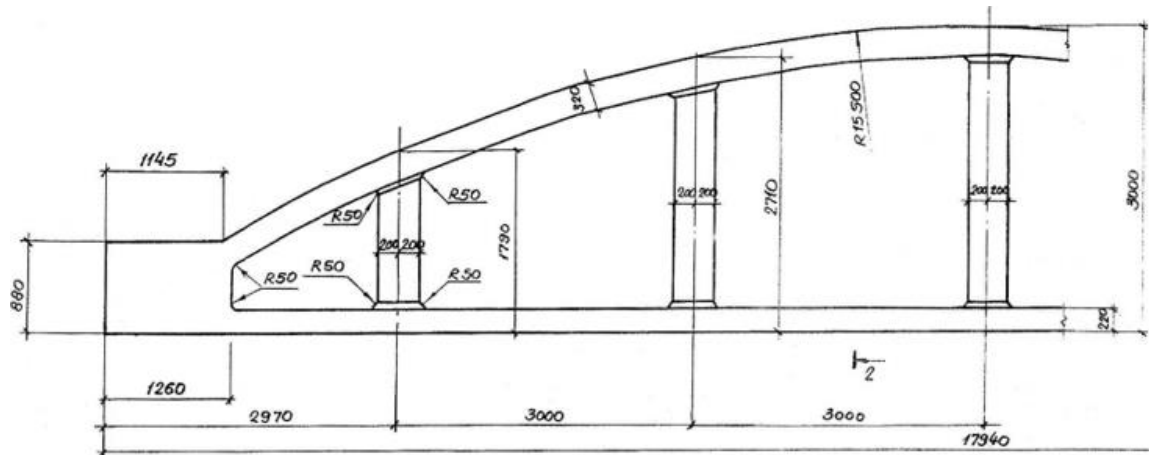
Прийняті безрозкосні залізобетонні ферми
